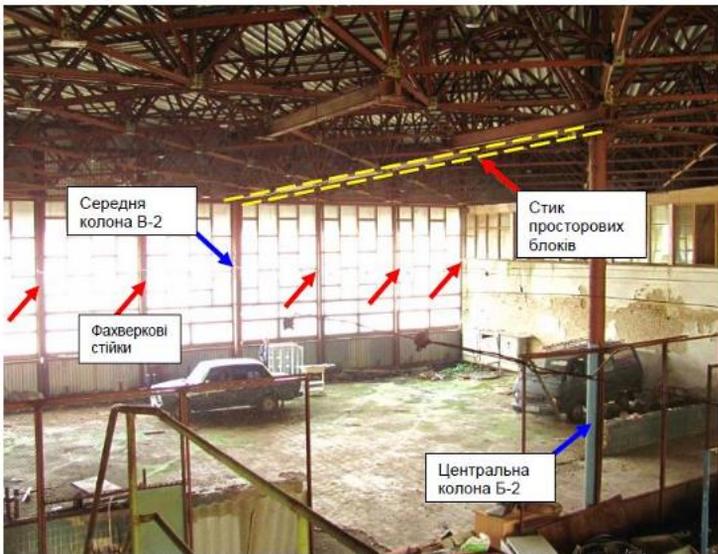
Плоскі ферми з кроком між фермами 2121мм та під кутом 45°. Обпирання ферм на фажверкові стійки з кроком 3м.
